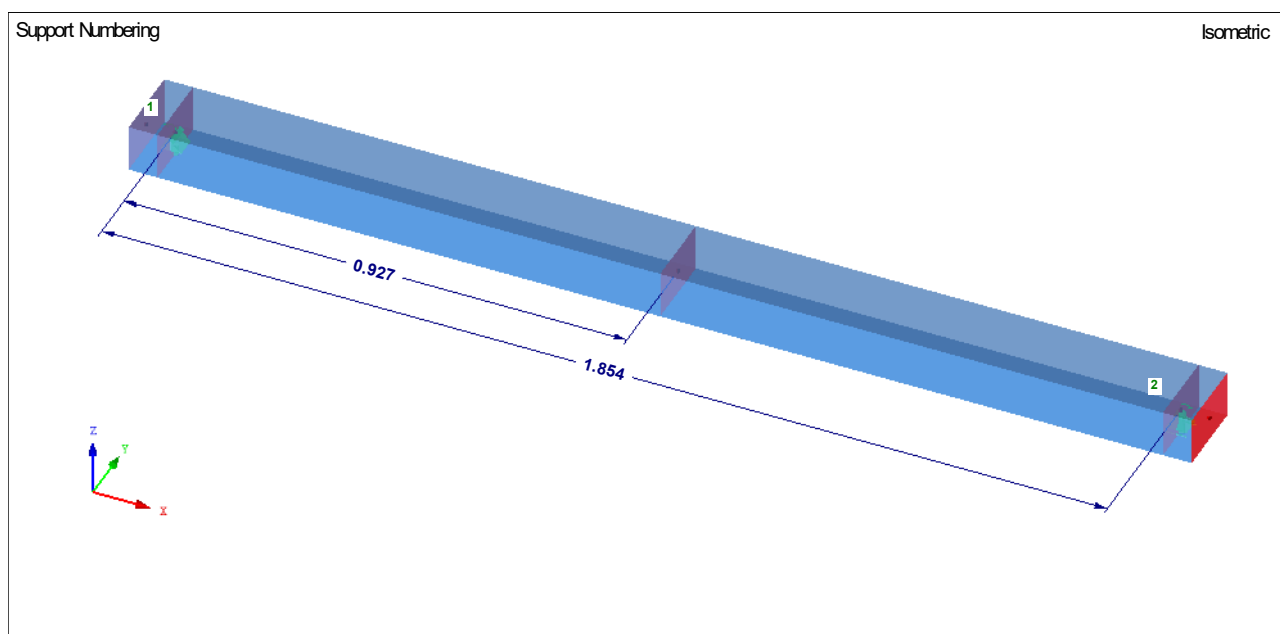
Загальний вигляд розрахункової схеми у Dlubal RFEM 5 (1- шарнірно нерухома; 2- шарнірно рухома опора)
